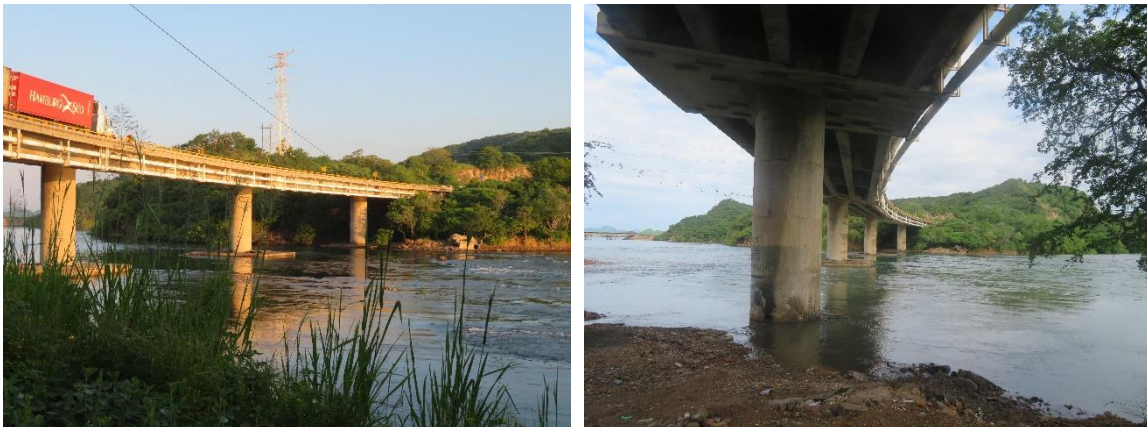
Puente Tepalcates II con cimentación sobre la Laguna de Cuyutlán.
